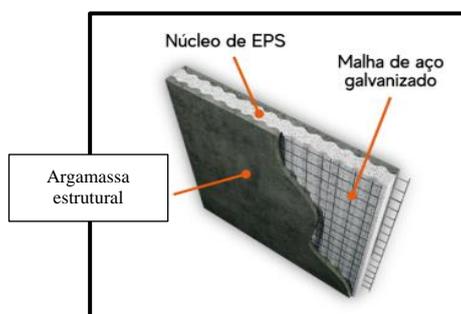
Demonstração do Sistema Construtivo em Painéis Monolíticos de EPS.
